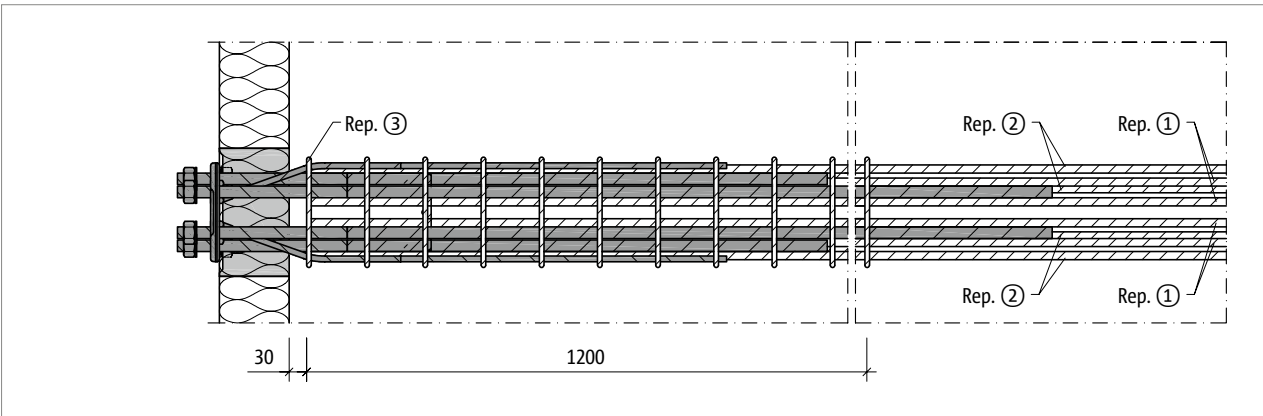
Schöck Isokorb® XT type SK-MM2 : armatures à prévoir par le client, vue en plan
